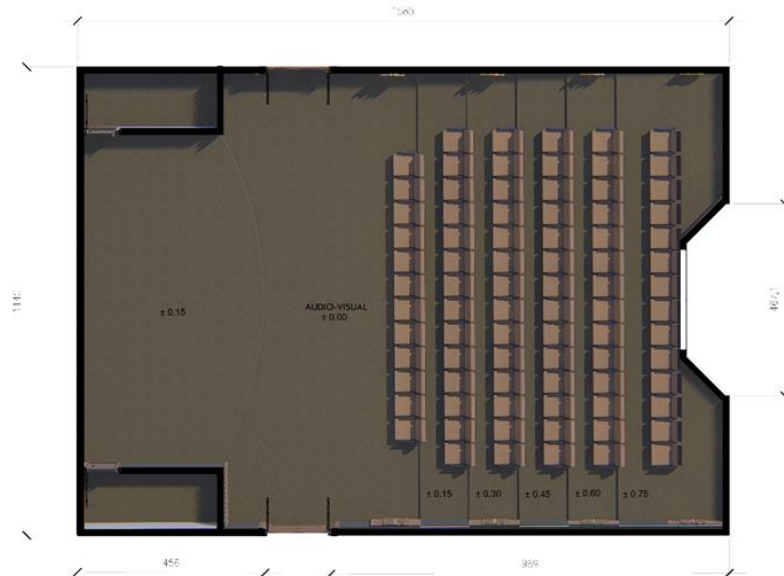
14 Detail Arsitektur Ruang Terpilih 1
